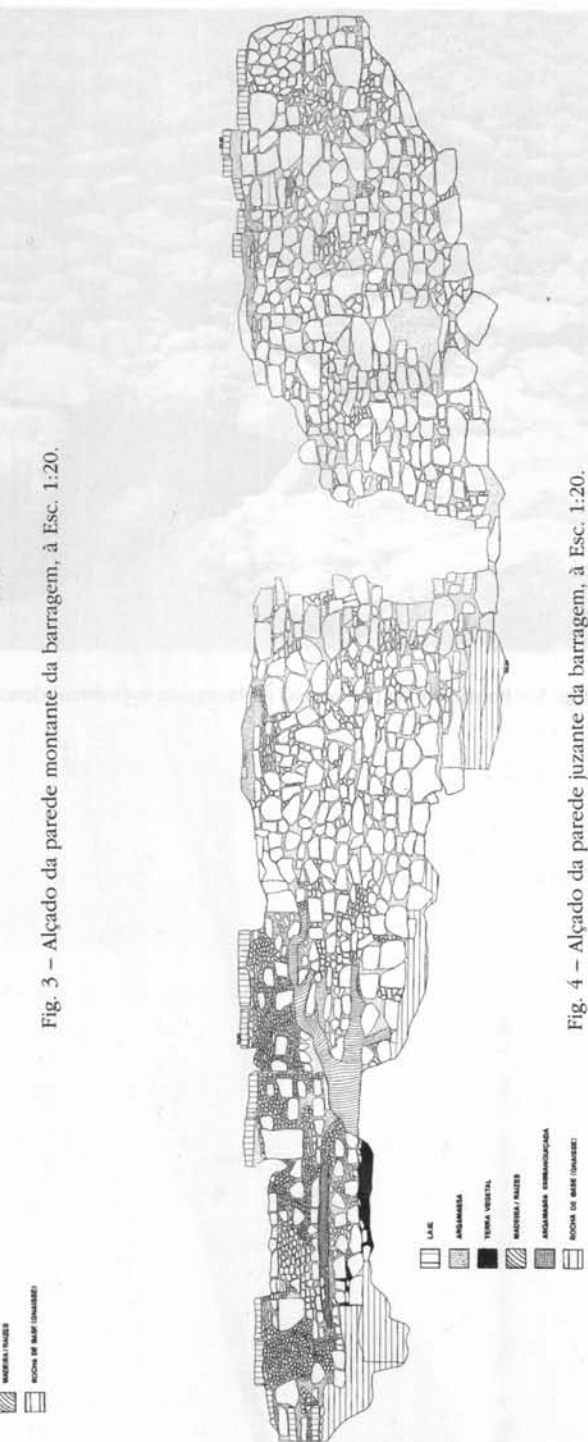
Alçado da parede juzante da barragem, à Esc. 1:20.
